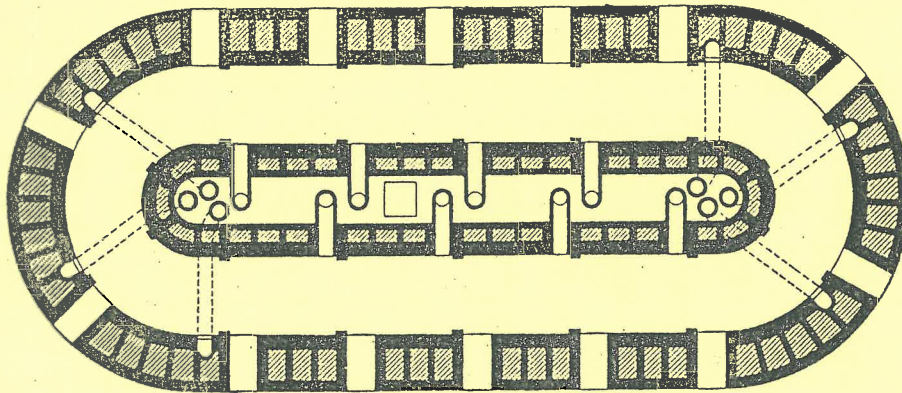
Länglicher Ringofen mit runden Endkammern. Grundriß.
